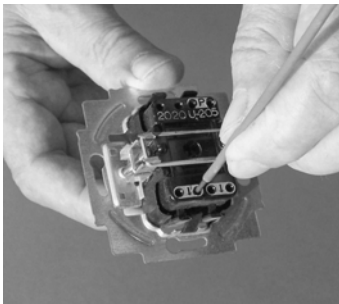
Schraubenlose Anschluss-Steckklemmen: Das abisolierte Leiterende wird in die Klemme nur hineingesteckt – und schon ist ein (oft lausiger) Anschluss erstellt.
